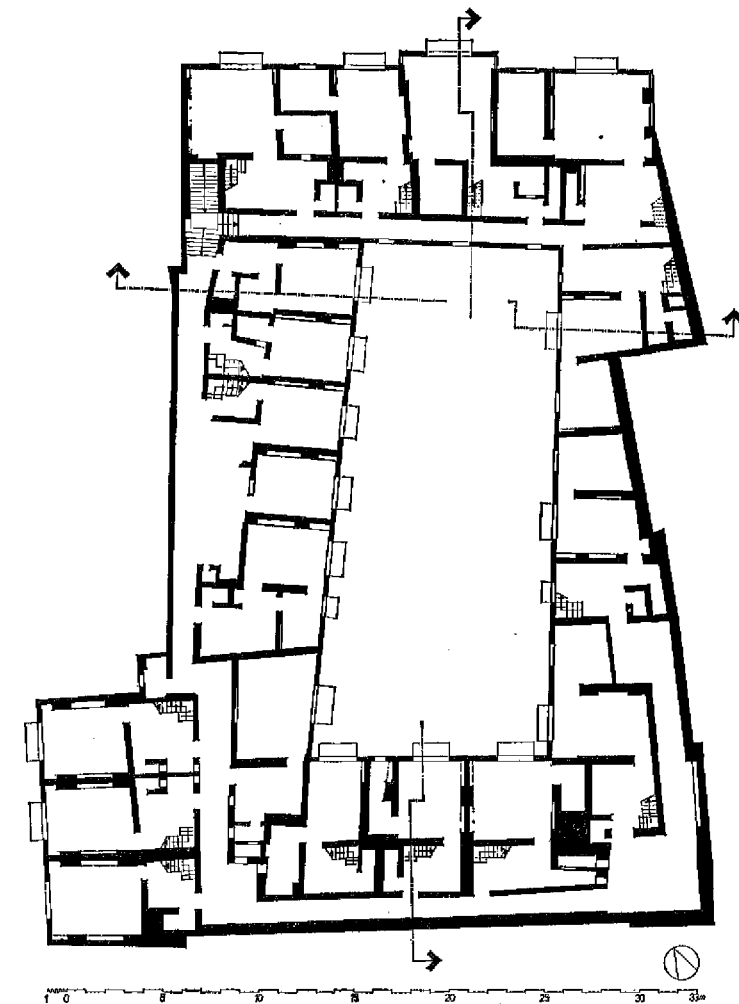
Kairo, Wakalat al-Bazar'a, Grundriß — zweites Obergeschoß
